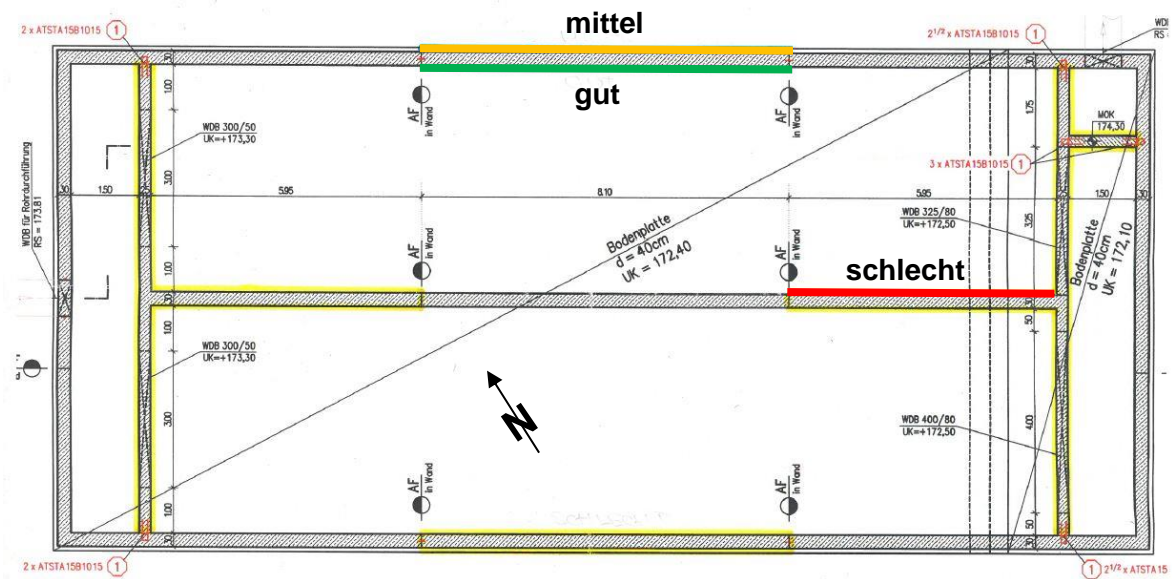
Grundriss des Absatzbeckens mit eingezeichneten Untersuchungsbereichen
